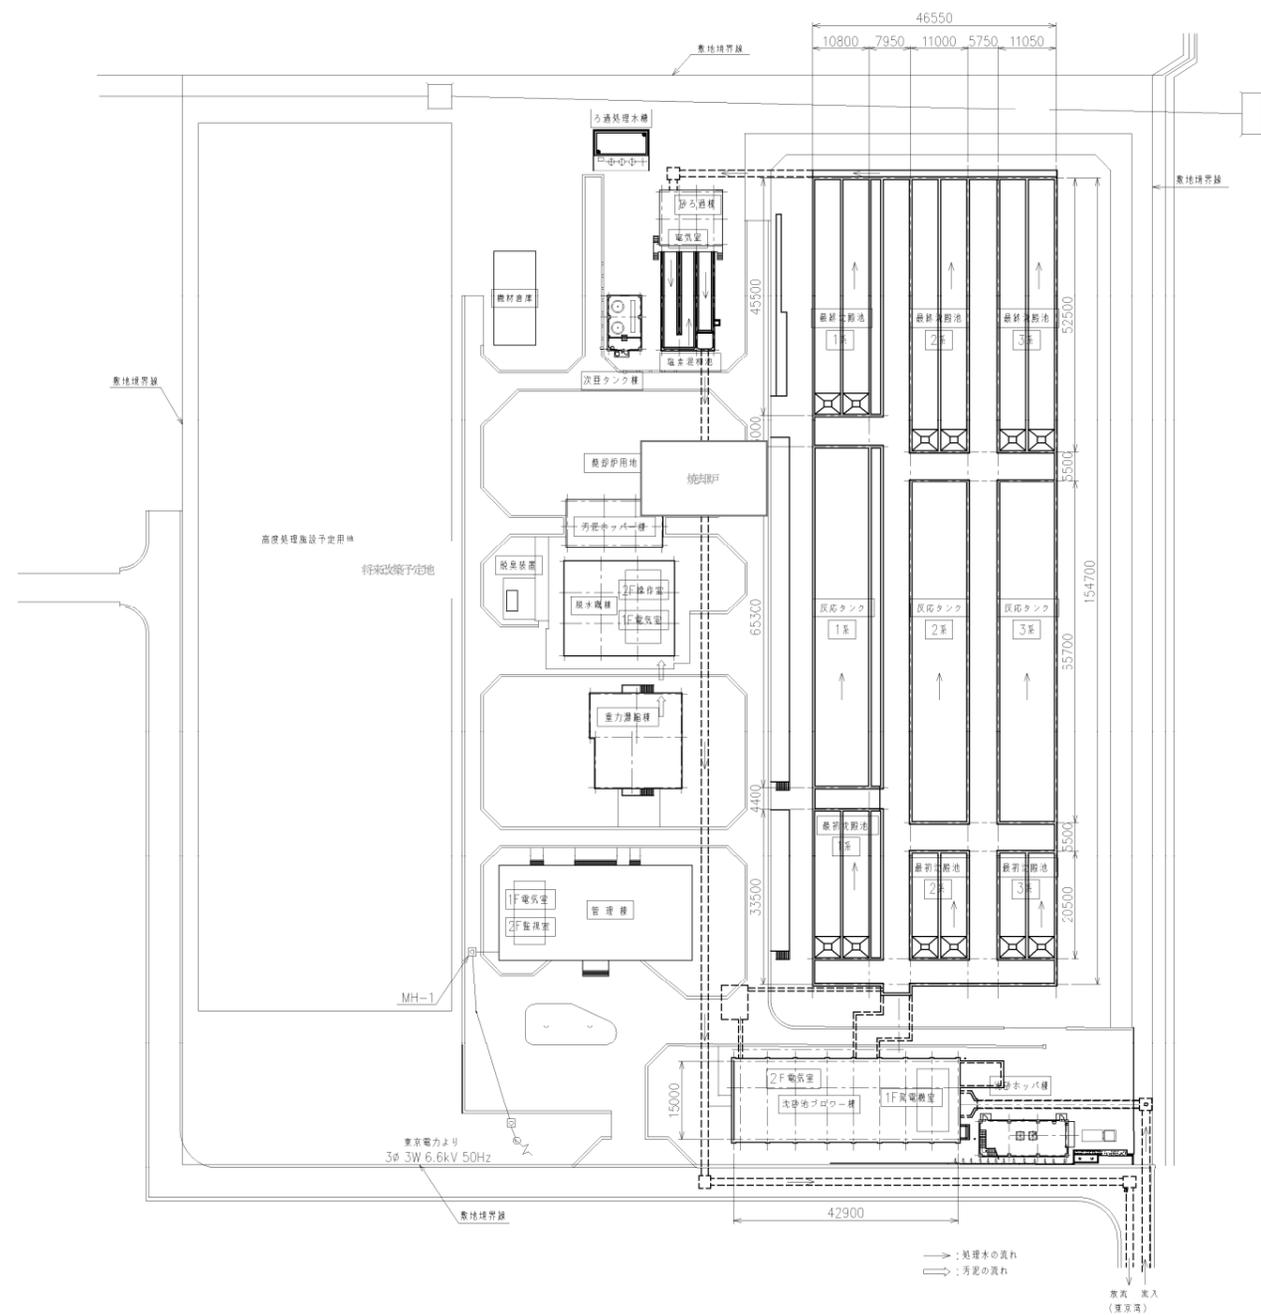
袖ヶ浦終末処理場 一般平面図 (全体計画見直し)
